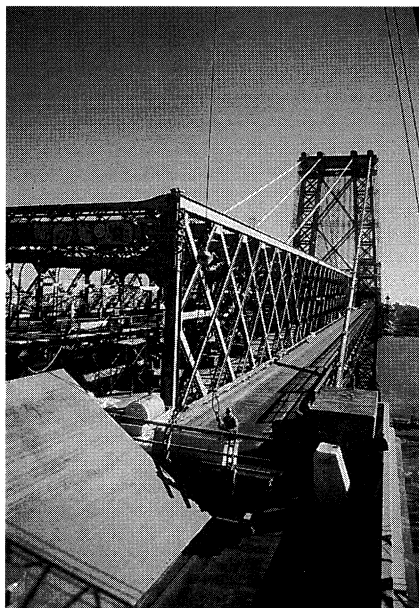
ウィリアムズバーグ橋 鋼床版への交換
